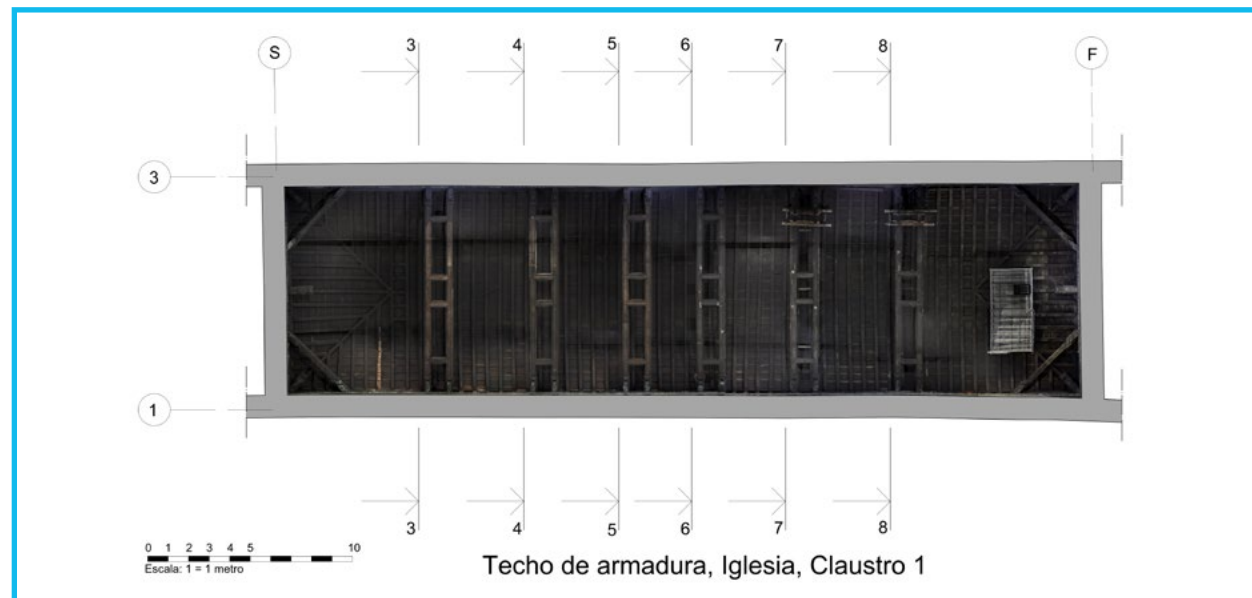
Ortoimagen obtenida de la planta del techo de armadura de la iglesia, bloque A, primer claustro
